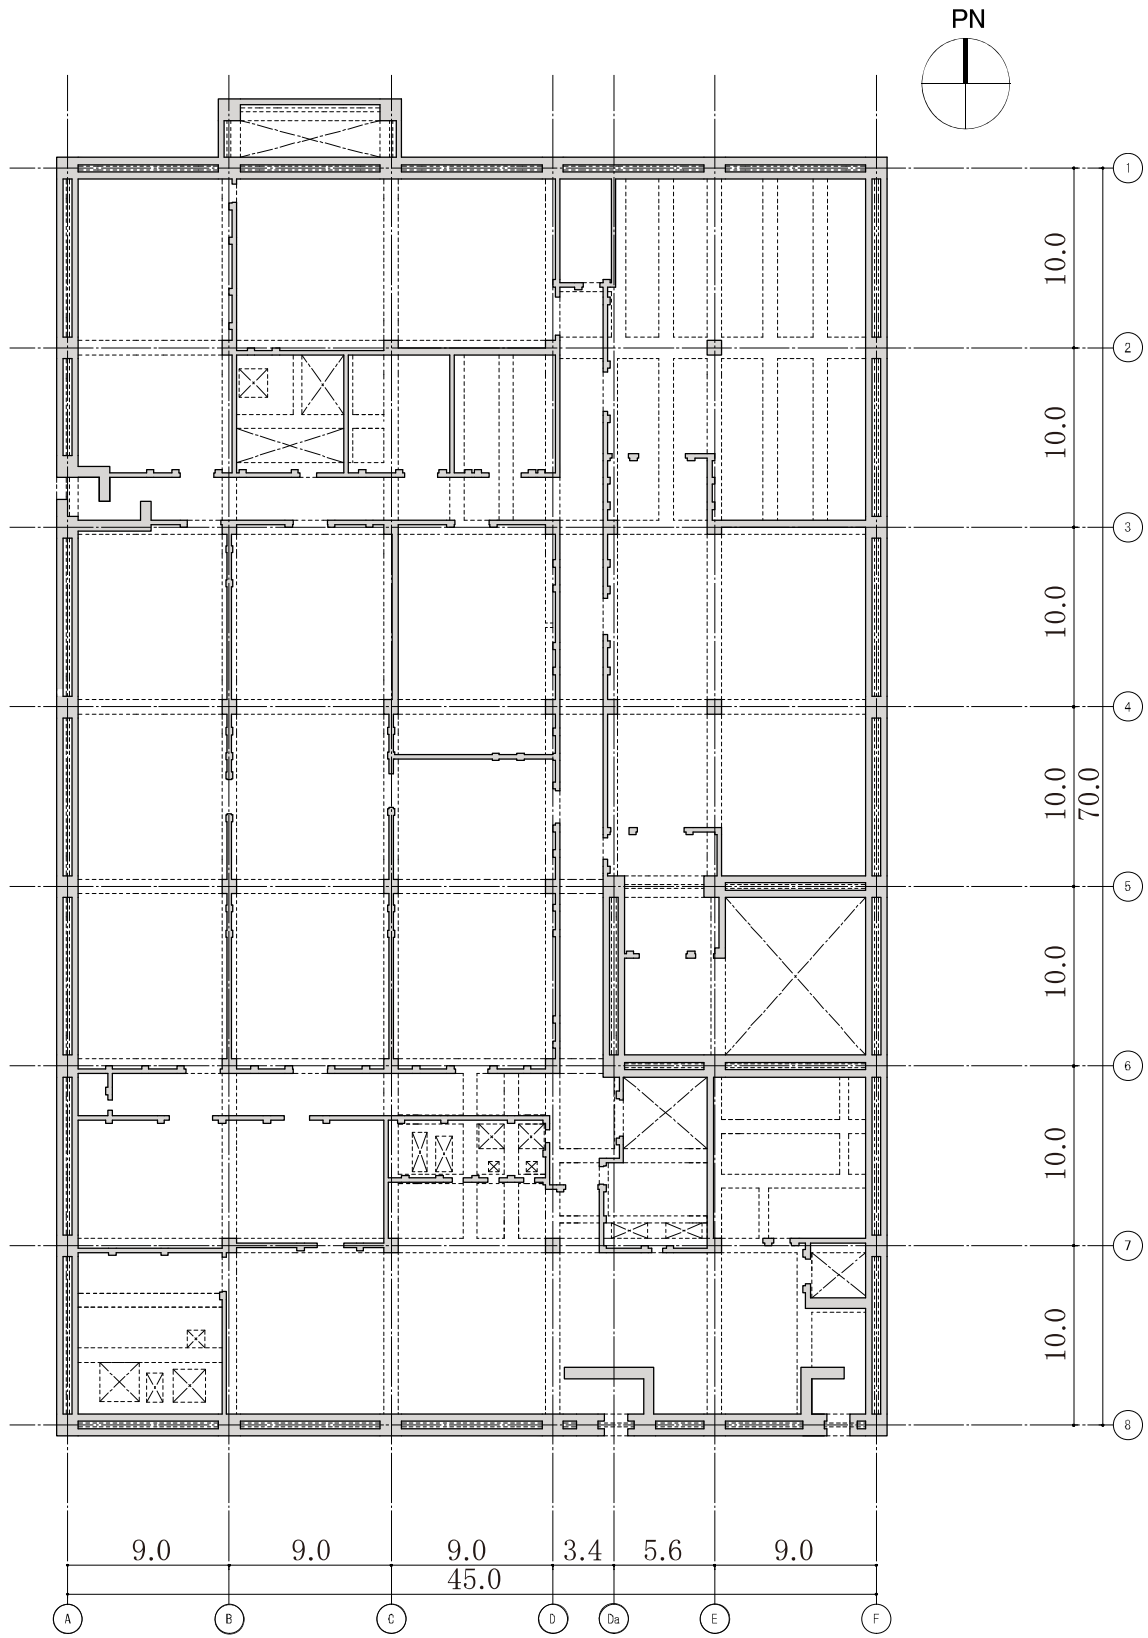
2階平面図 (G.L. +8.80) (単位 : m)
